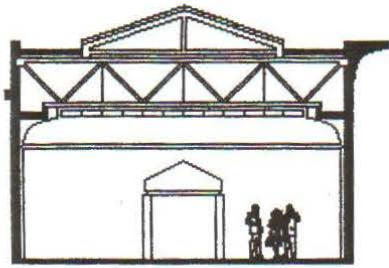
Plafon bistrat la Noua Galerie Națională Stuttgart 1984 arh. J. Stirling
